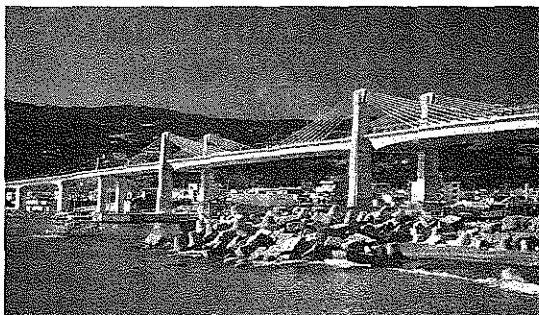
Puente de hormigón con Pretensado Extradosado. Puente de Odawara Blueway, Japón (1994).
